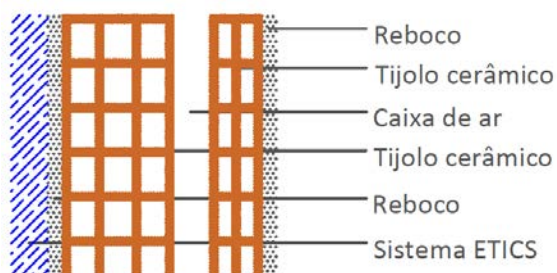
Solução construtiva tipo de parede exterior – Pós intervenção
